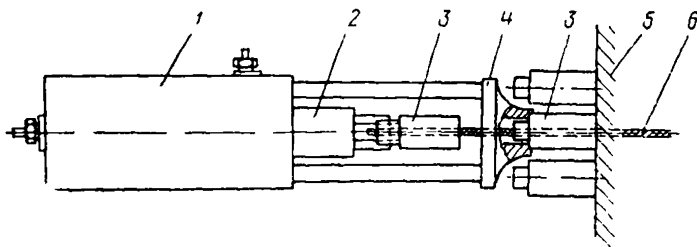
Приспособление для натяжения прядевой арматуры с упором домкрата на корпус зажима
